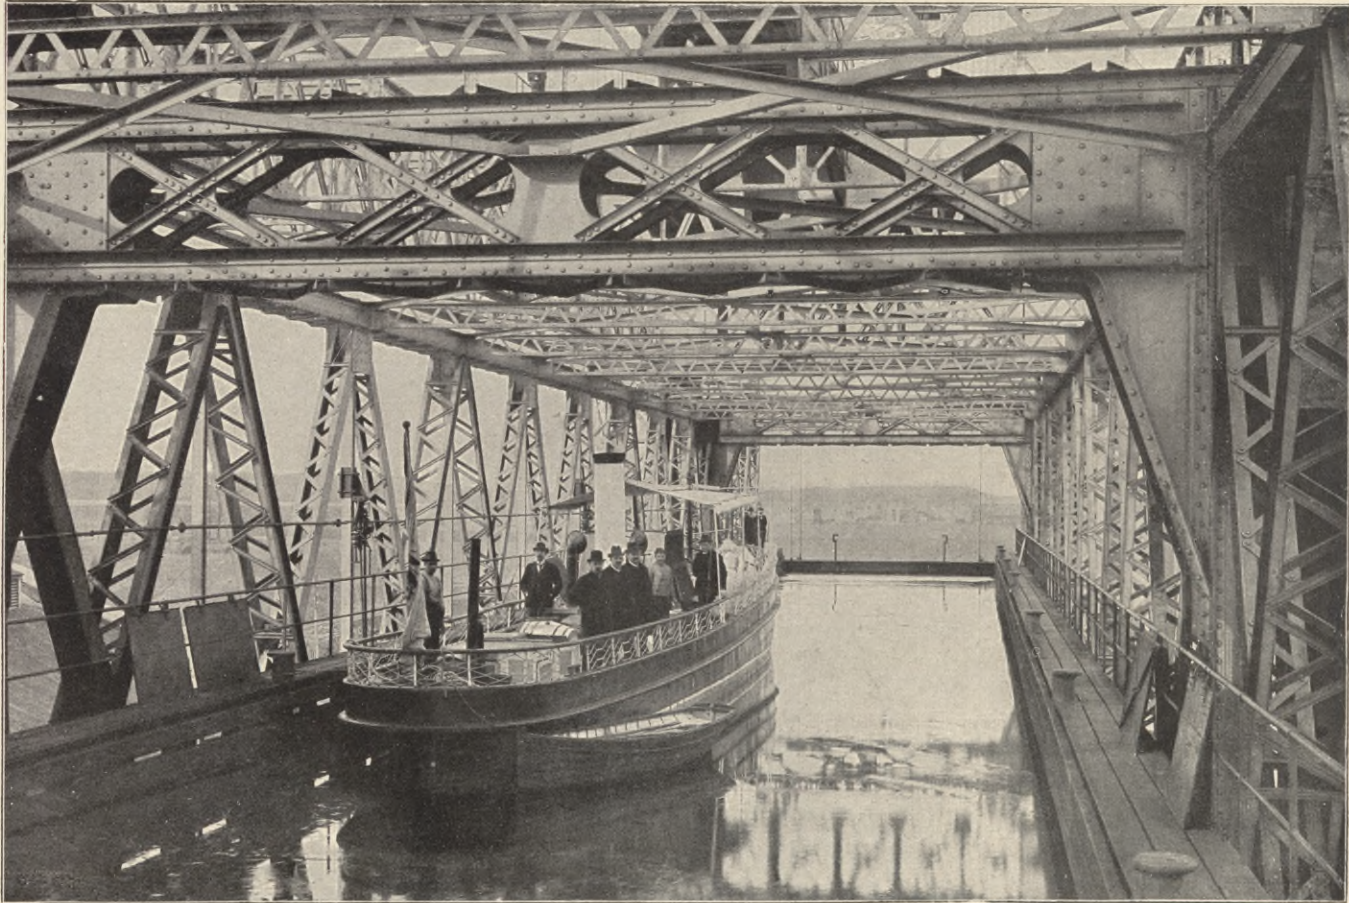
EISENKONSTRUKTIONEN ZUM SCHIFFSHEBEWERK IN HENRICHENBURG,
